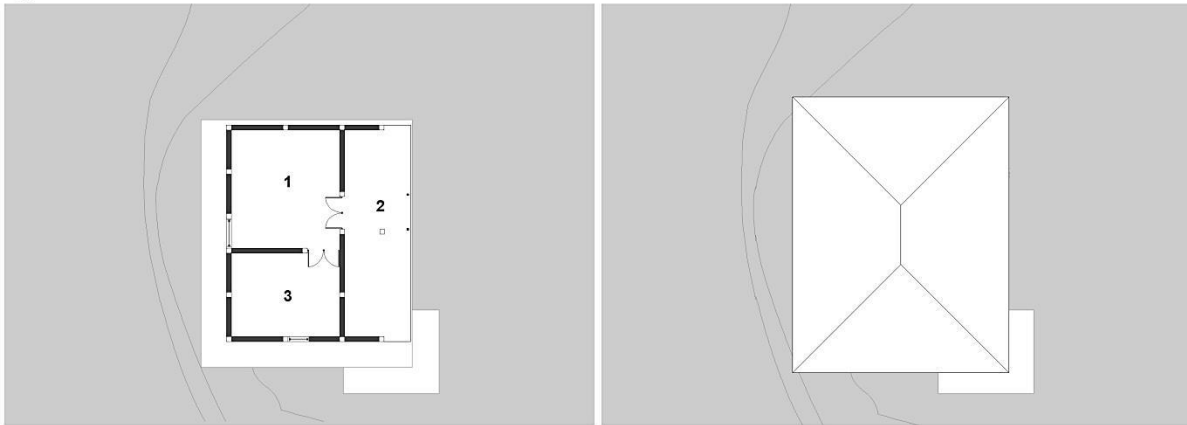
Planta Arquitectónica vivienda de bloques de concreto. Autor: Paúl Rivas Rivas.
